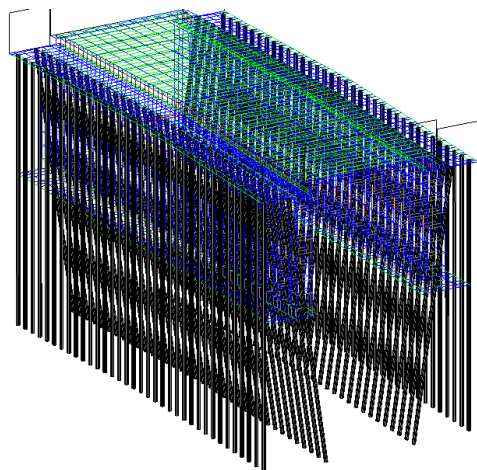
Modello 3D - Particolare dei pali di fondazione
